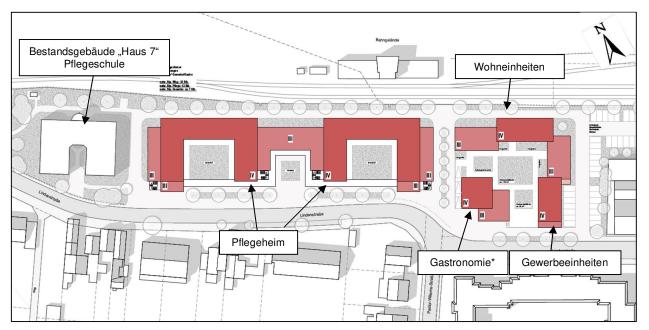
Gebäudeplan der Baukörper (ohne Maßstab, Quelle: /3/)
